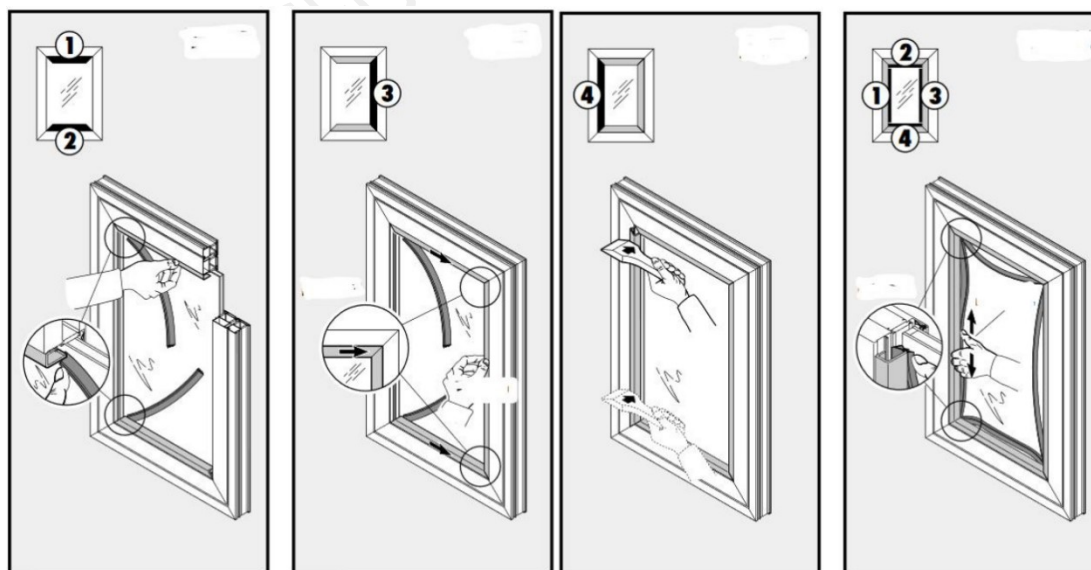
4 . *Bewegingsrichtingen met een rubberen hamer bij het installeren van PVC-lijsten
